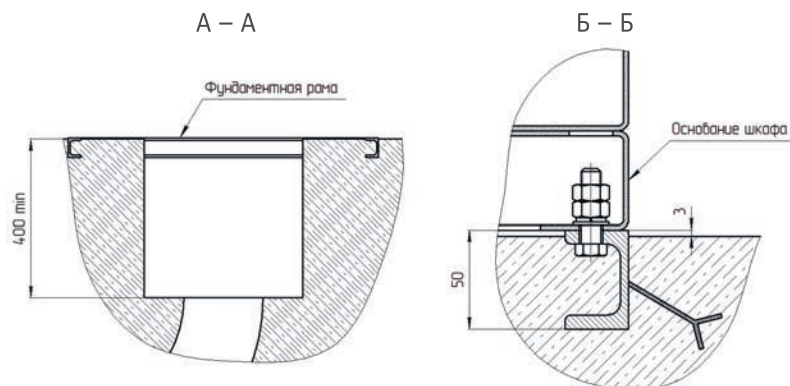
Пример конструкции фундаментной рамы и кабельного приемка
